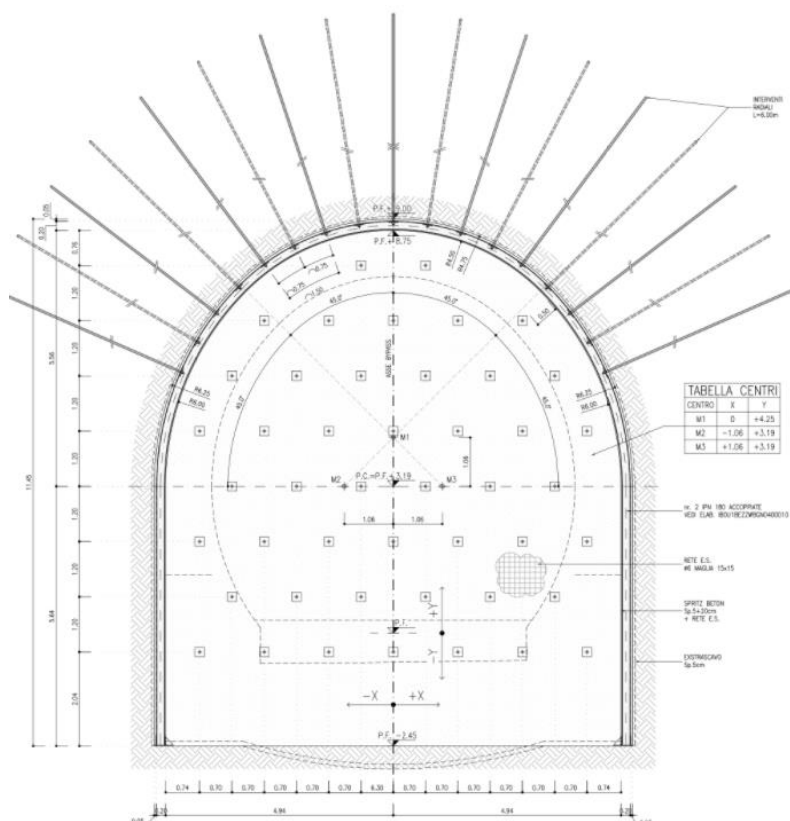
Carpenteria sezione innesto (IBOU1BEZZWBG0400008) – sezione B-B
